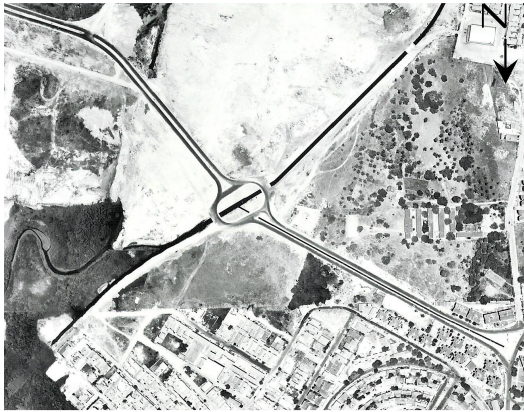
Vista aérea da região – futuro bairro Jardins. Destaque para as obras de aterro e terraplenagem e a construção dos canais ao longo das avenidas (1993).
